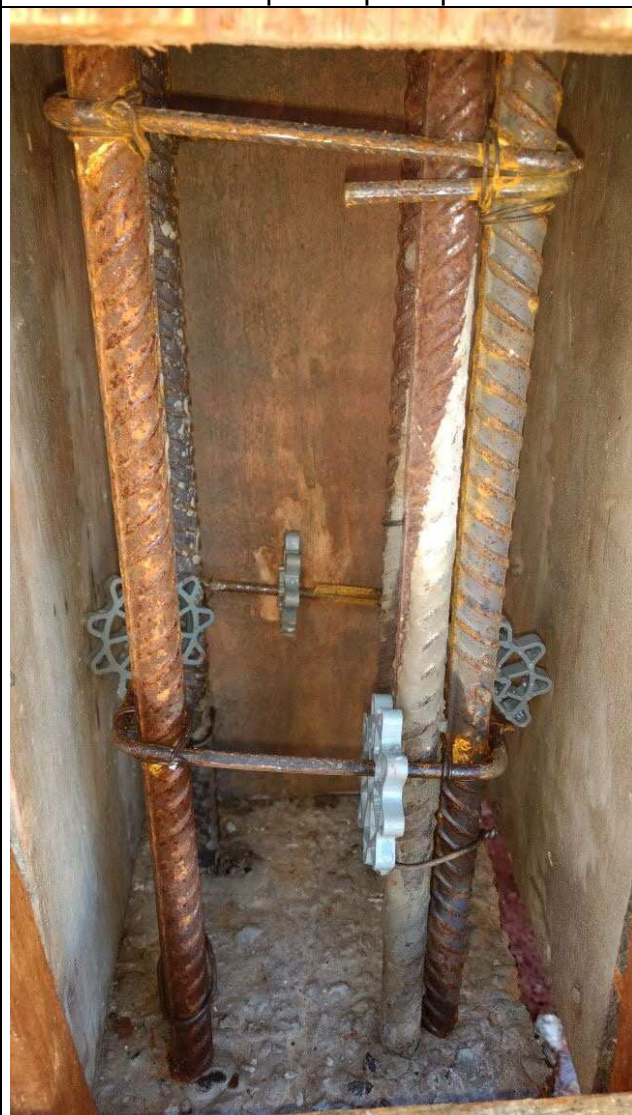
C: Formas e armaduras do pilar P54 do prédio principal.
